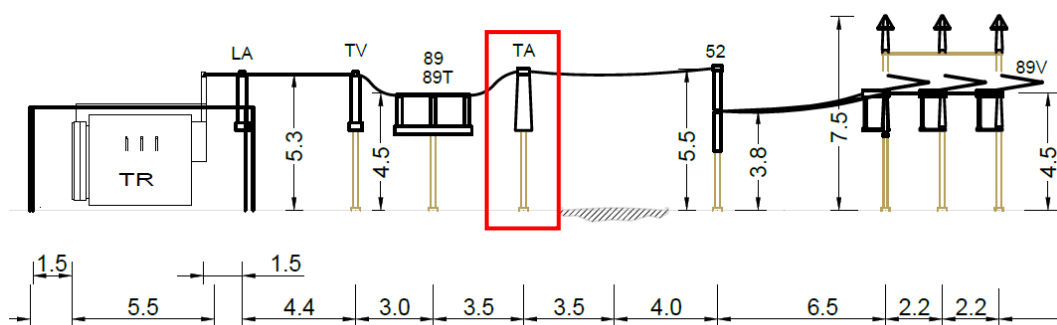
Sezione degli elementi della sottostazione utente (Nord)
